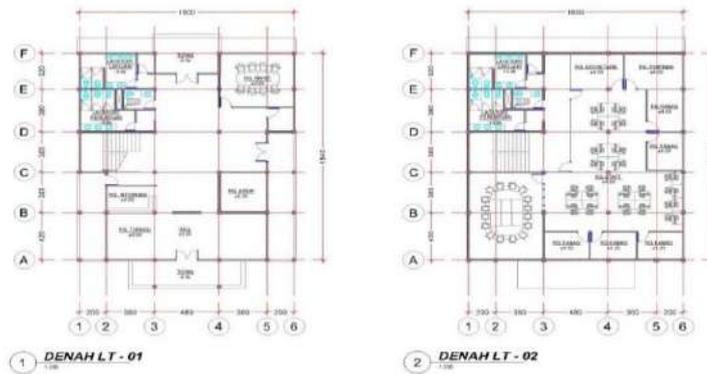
Denah Lantai 1 Toko Soevenir
